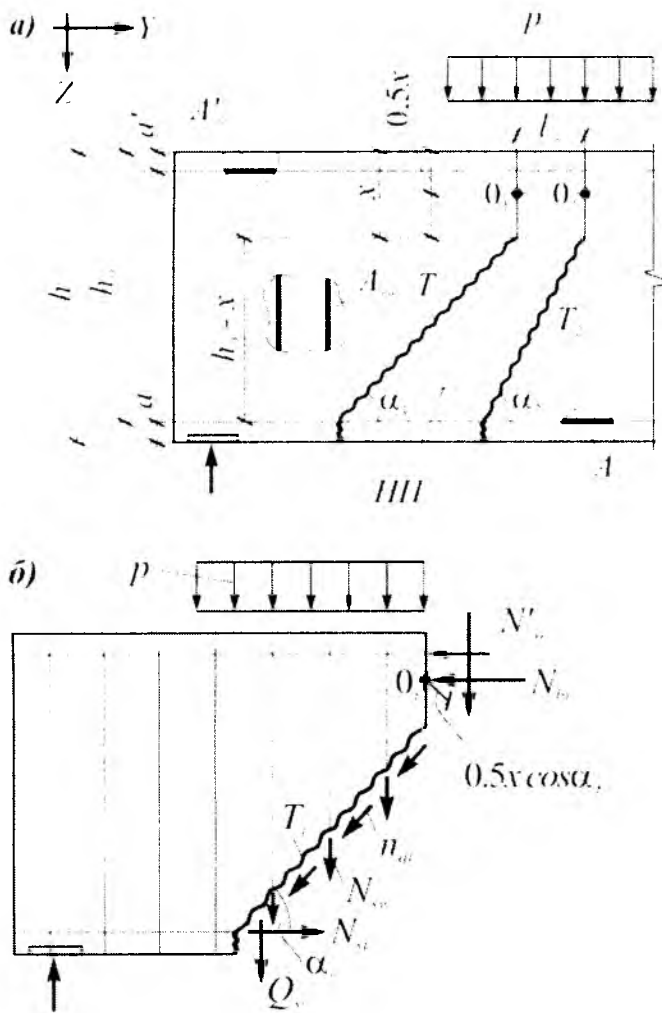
Общая расчетная полоса бетона (НП) между наклонными трещинами T_1 и T_2 с различными углами наклона α_1 и α_2 (а); (б) схема усилий в наклонной трещине T_i ($i = 1, 2$)
